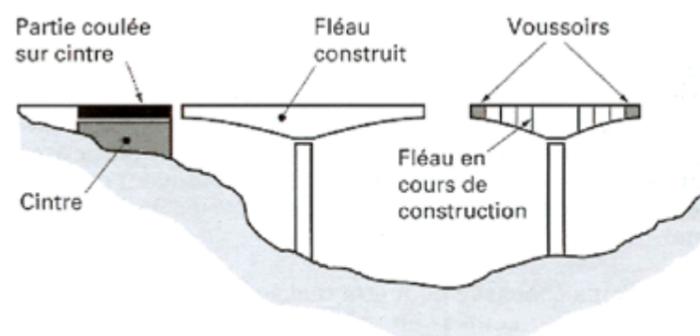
Principe de construction par encorbellement successif et coulage sur cintre
